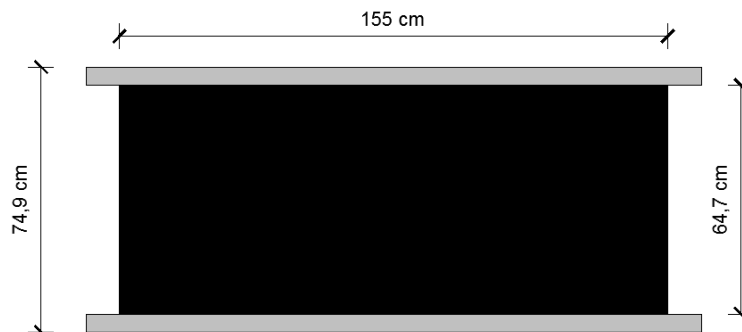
Dimensiones del aislador para el edificio de 30 pisos
